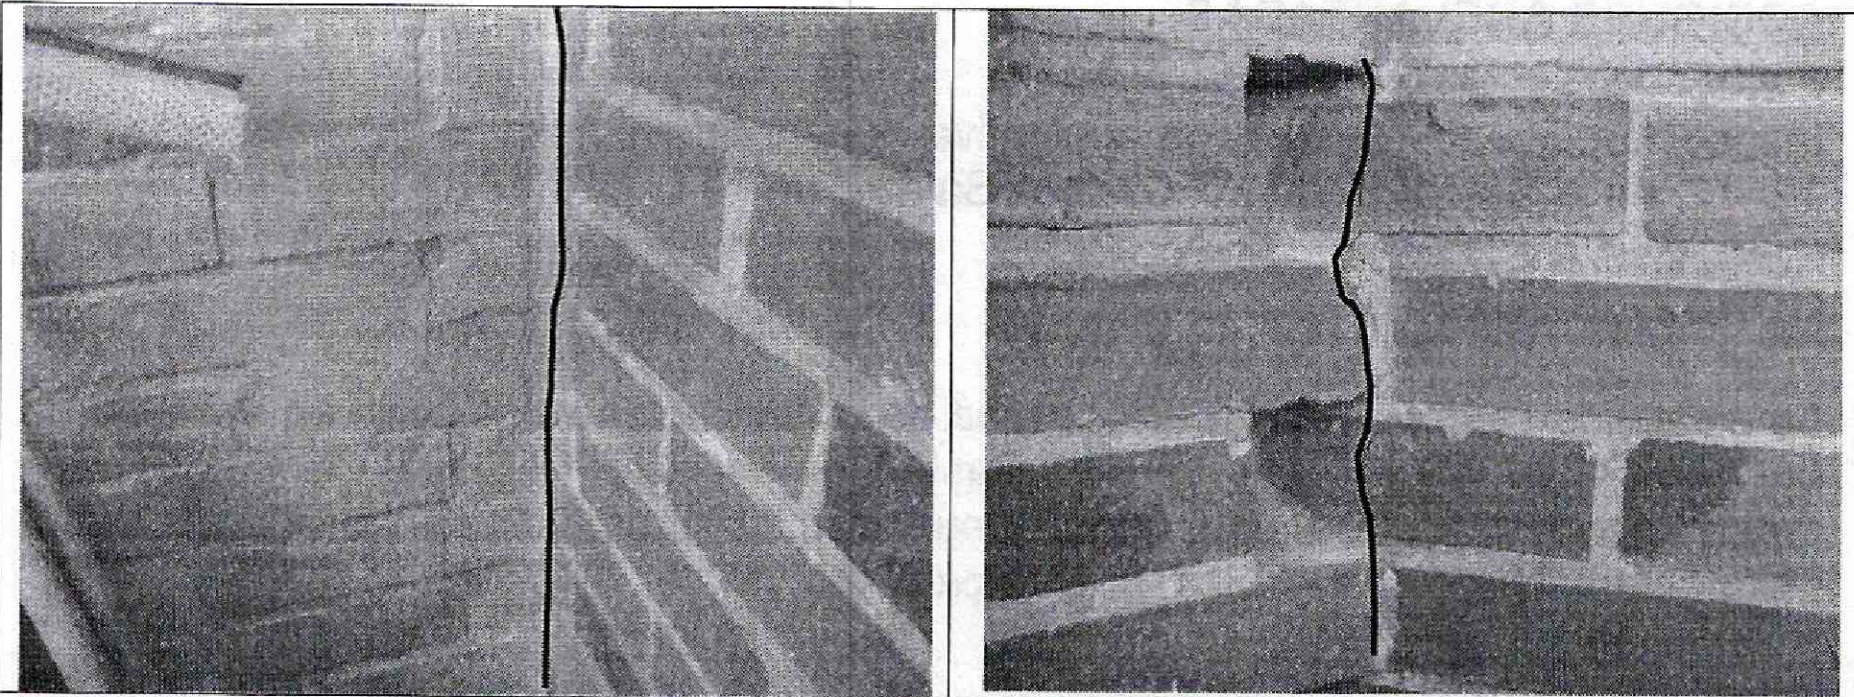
Vista de la fachada del predio de la Calle 147 N° 12-72
